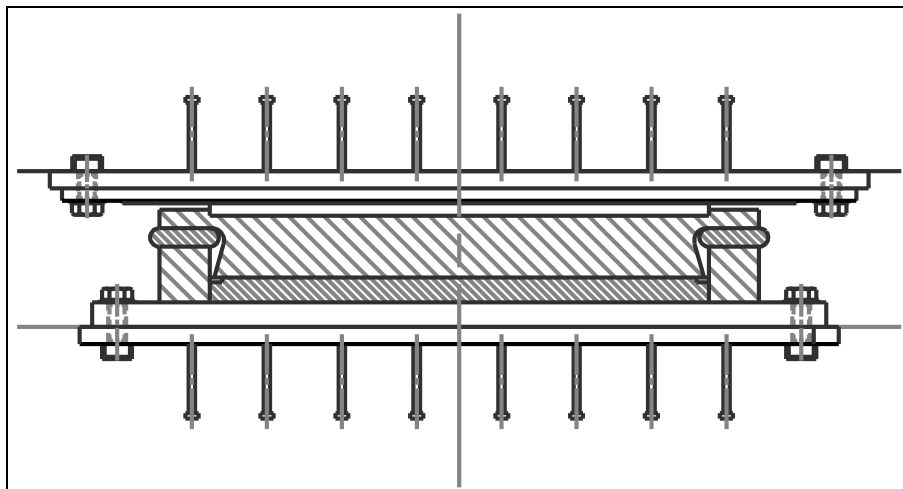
Overgangsplaten aan boven en onderzadel van een "vaste" potoplegging/ *Transition plates to bridge and pier or abutment
